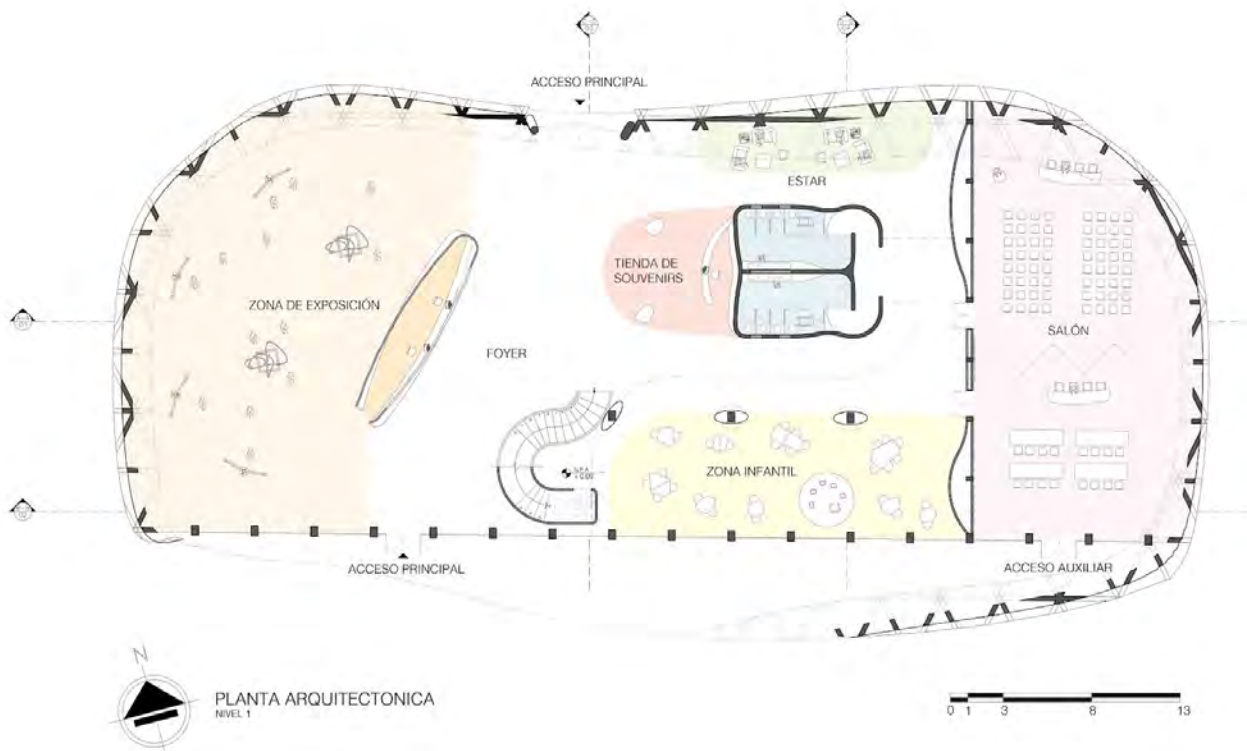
Planta arquitectónica, primer nivel. Elaboración propia.
